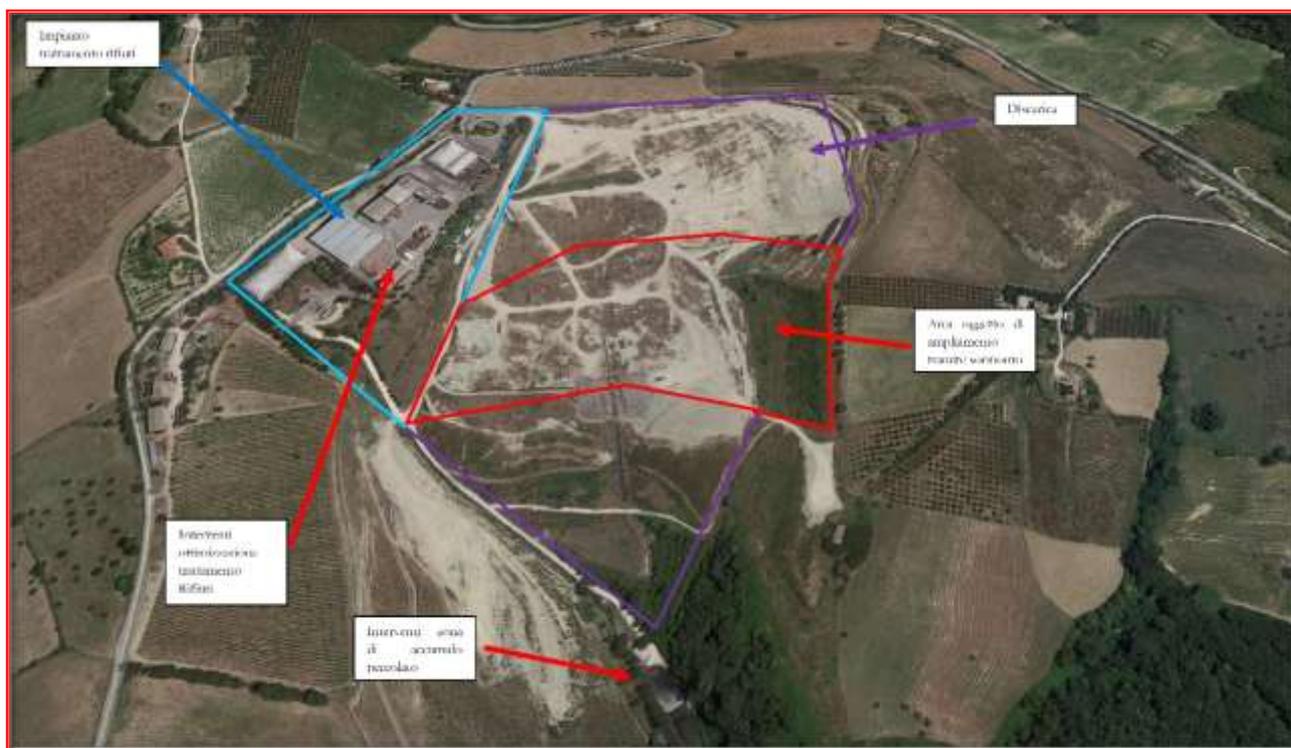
C.I.G.R.U. VISTA AEREA DEL SITO CON PLANIMETRIA IMPIANTI PRESENTI
